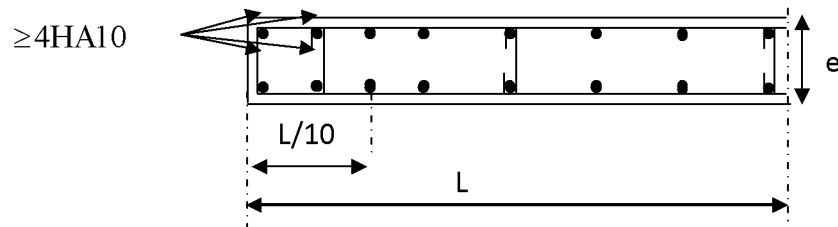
Disposition des armatures verticales dans les voiles.
